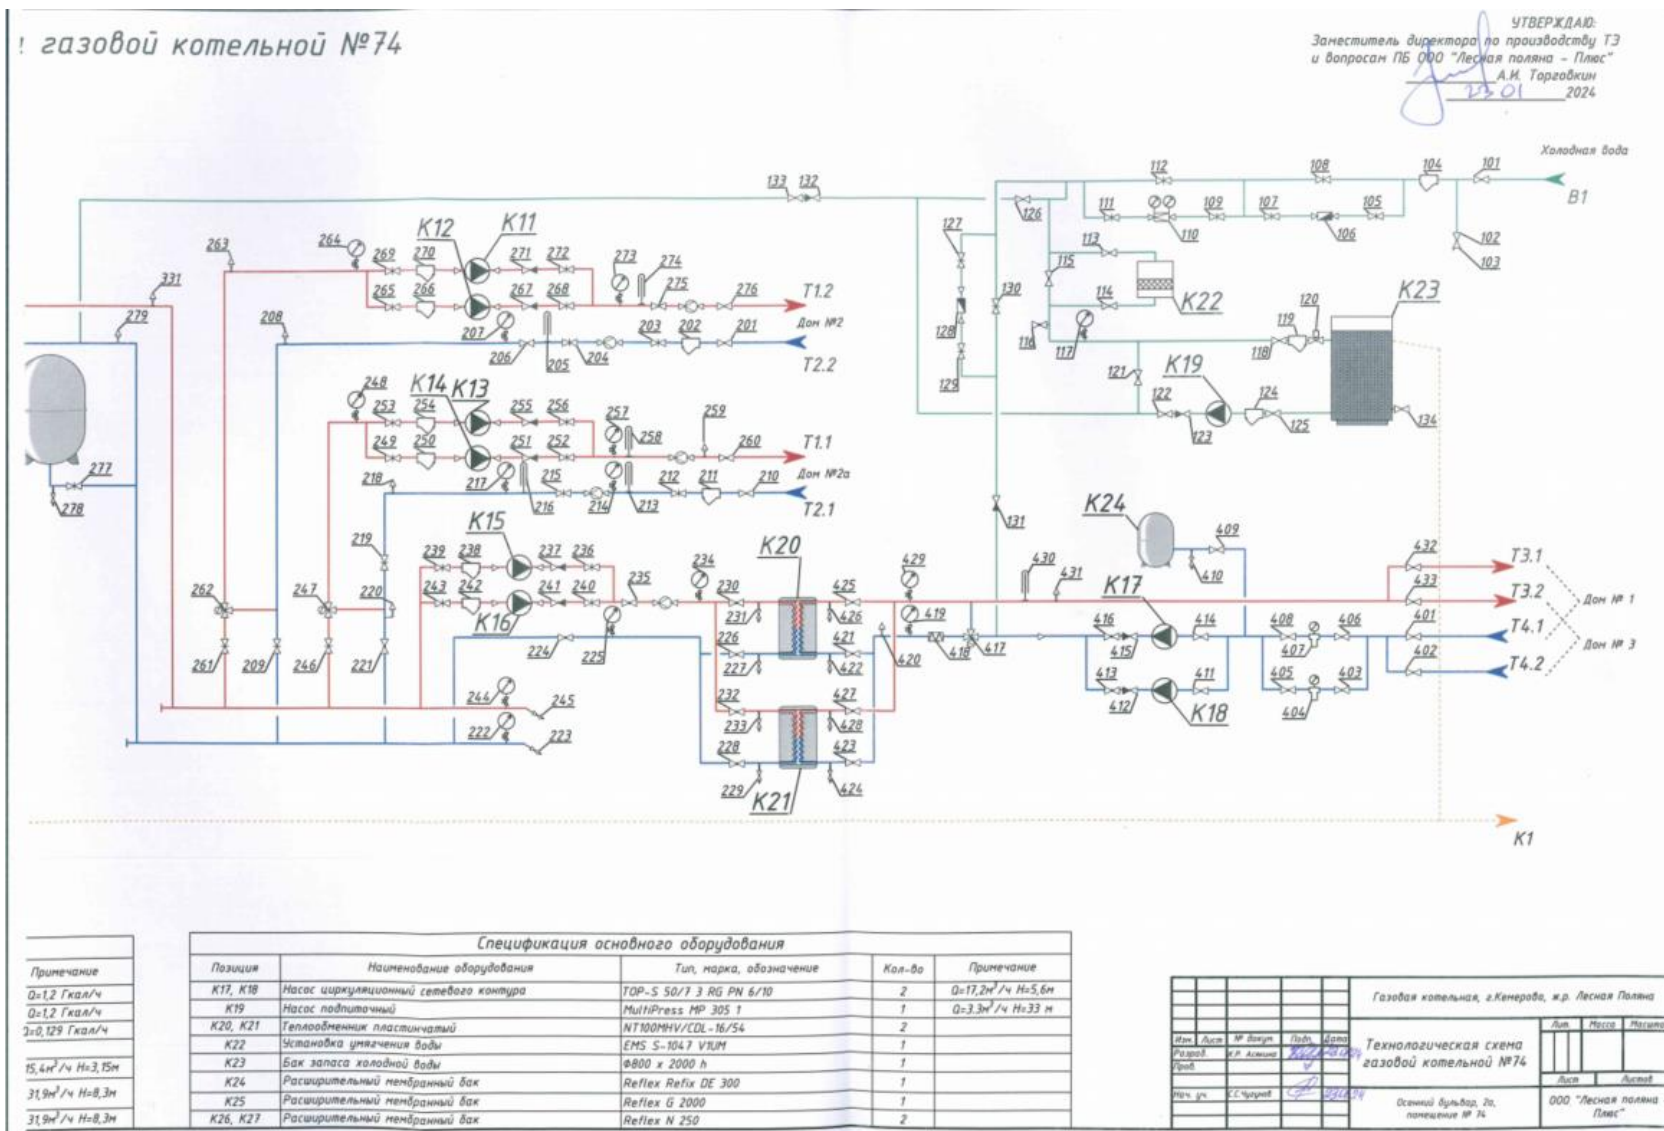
Тепловая схема Котельной № 74 (2)
